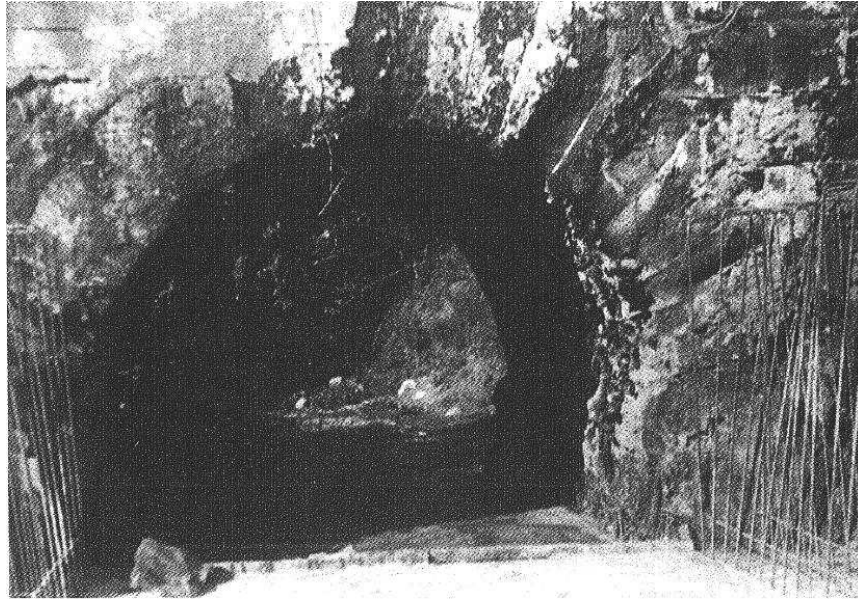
Alzado aguas abajo previo a la ampliación (Melchor 1995: 86).
